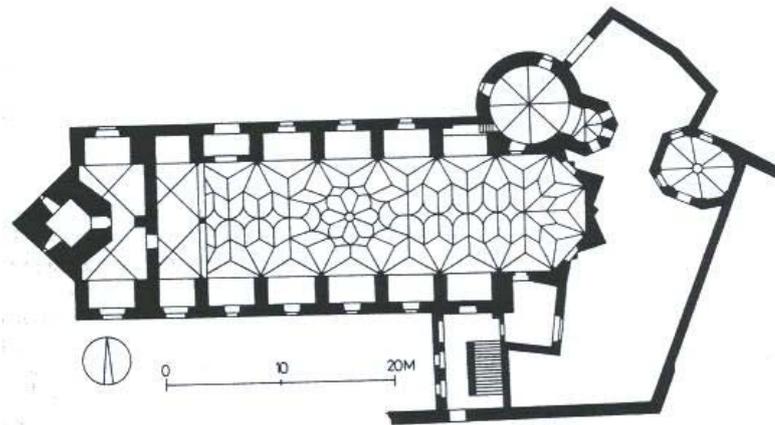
Pernegg, ehemalige Stiftskirche: Grundriss.
